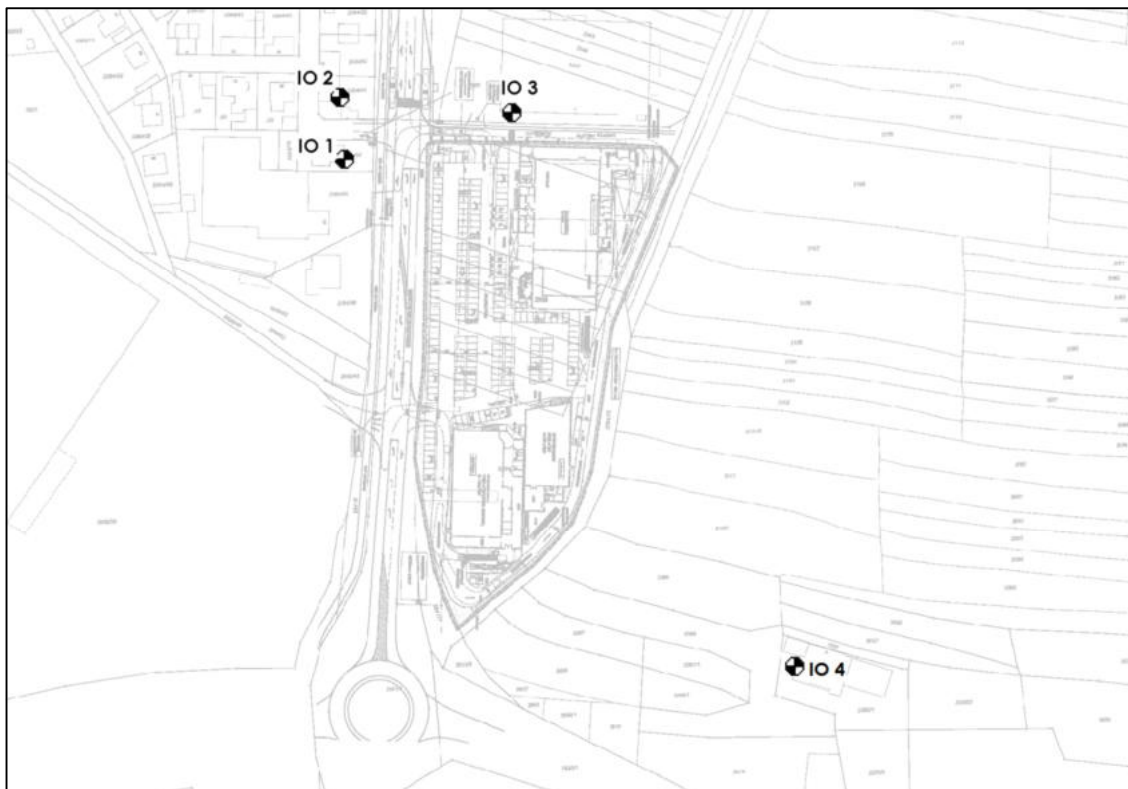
Lageplan /18, 31/ mit Darstellung der maßgeblichen Immissionsorte (IO)
